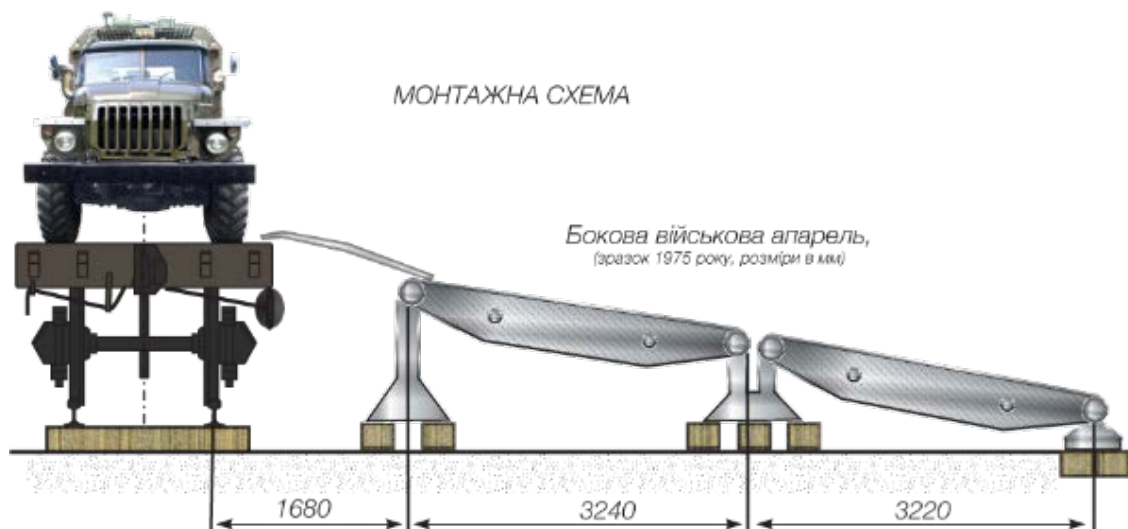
Бокова збірно-розбірна металева апарель (ЗРМА).
